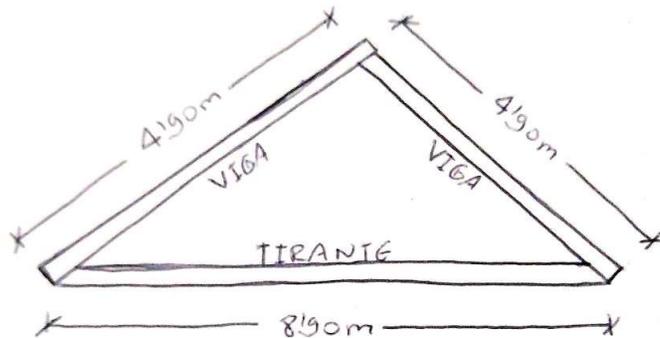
Longitud barras que conforman la cercha. Fuente: Elaboración propia
